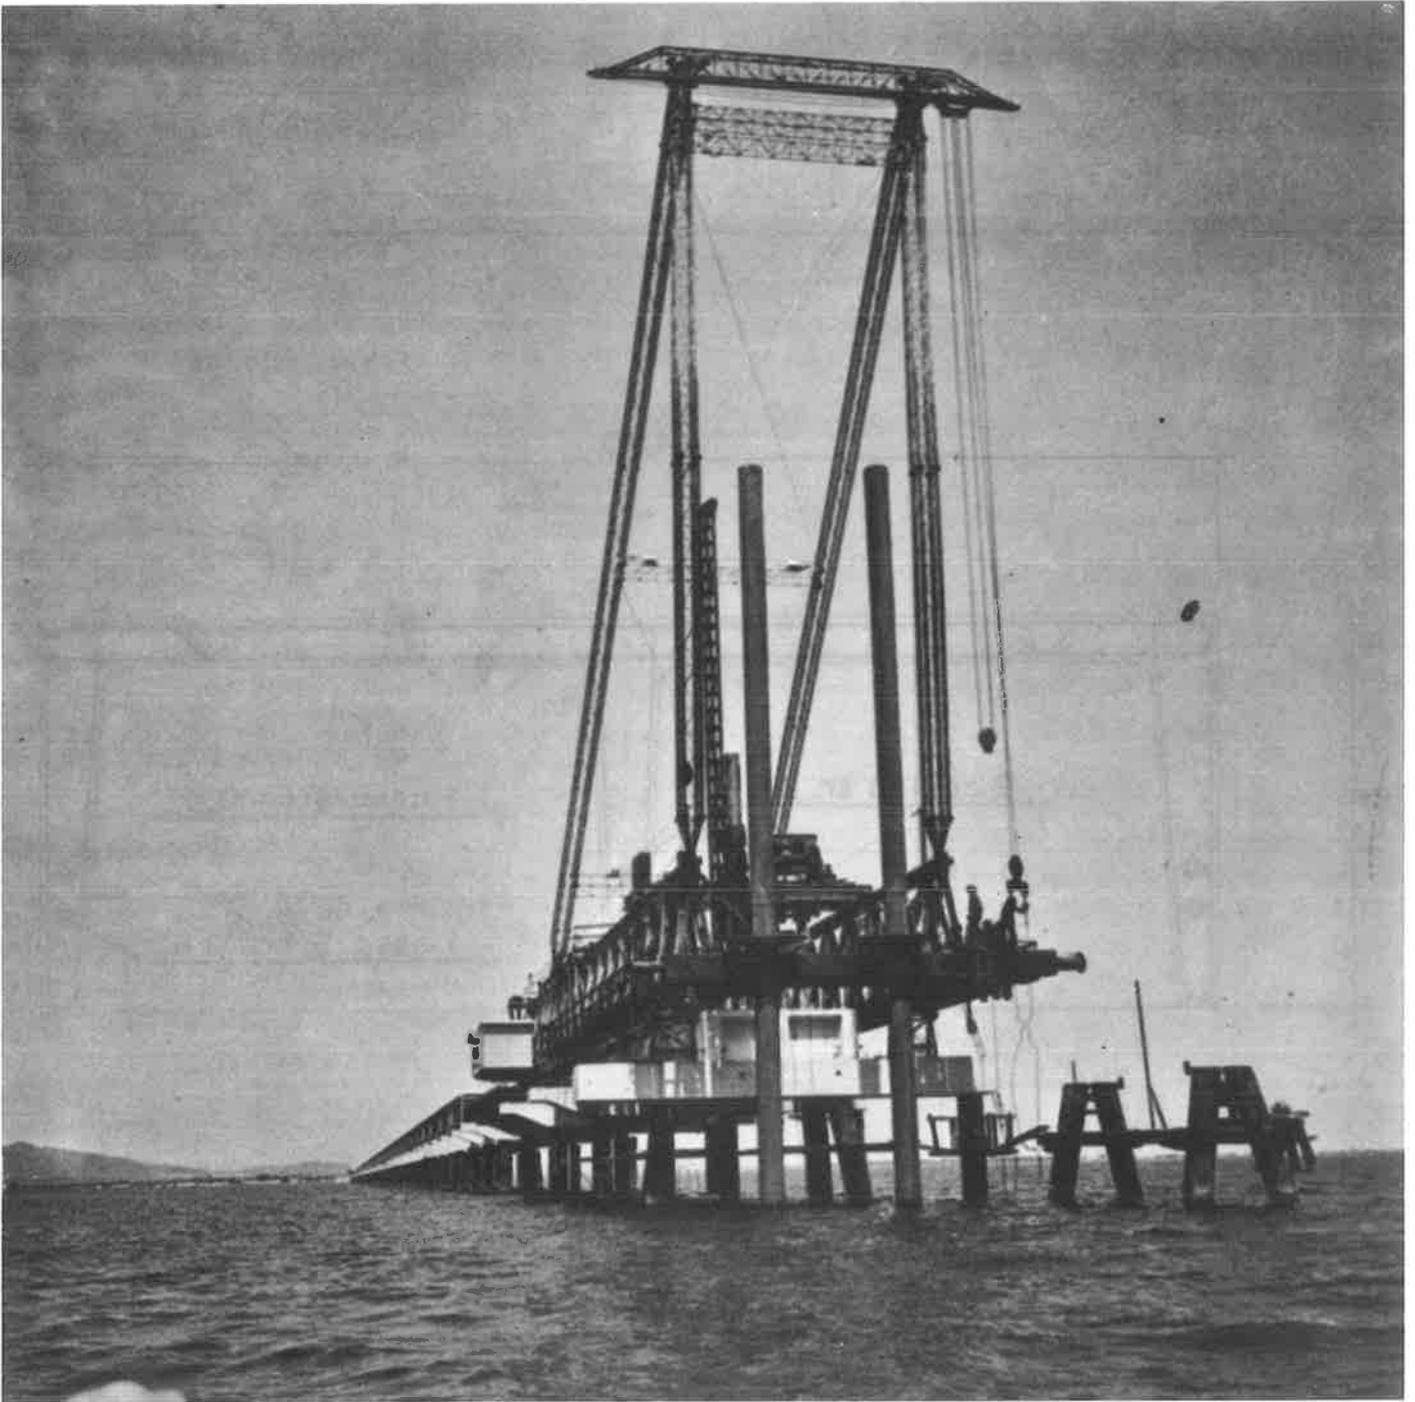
Pontile RUMIANCA - Traliccio di varo con battipalo in testa
